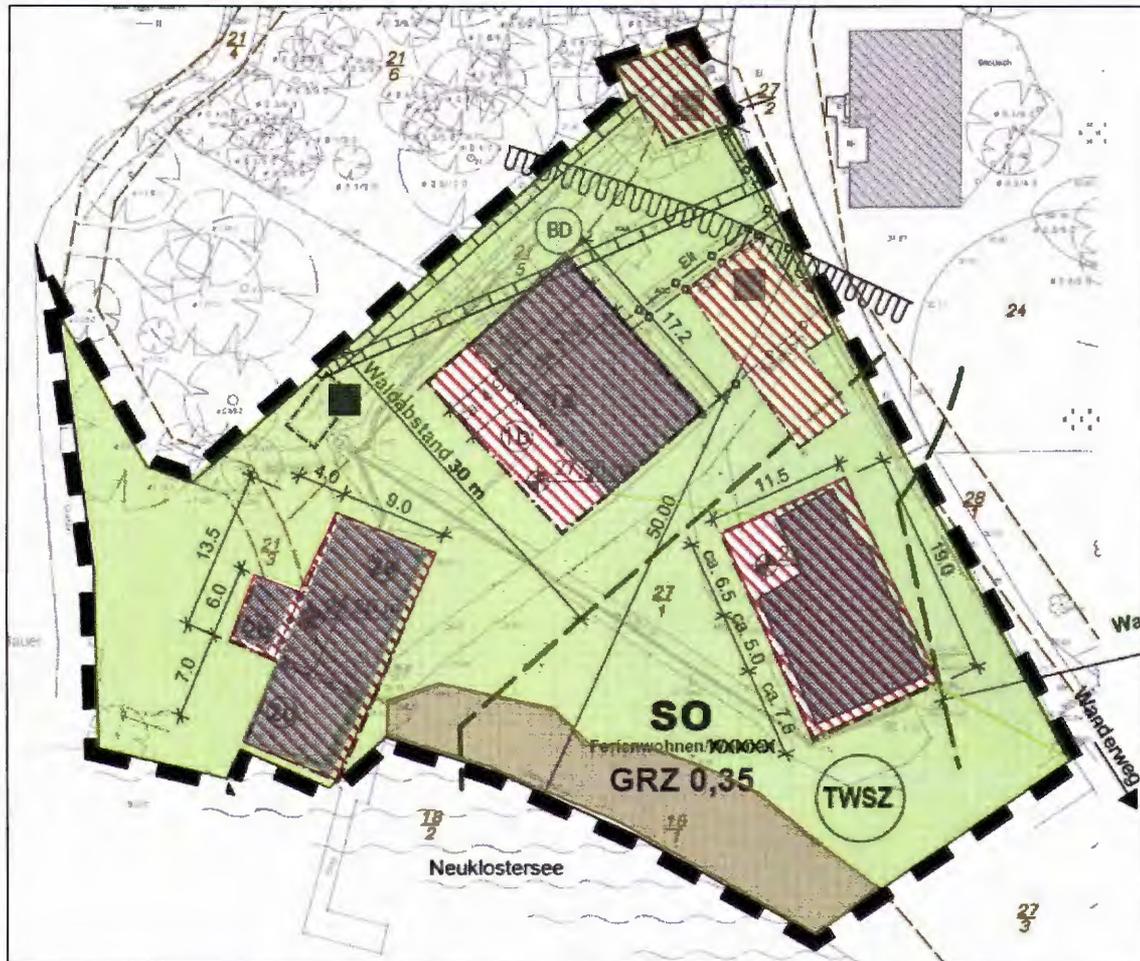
Darstellung der Biotoptypen im Eingriffsbereich. Grün: PGZ „Ziergarten“; Olivgrün: VRP „Schilfröhricht“; Grau: vorhandene Gebäude; Rote Schraffur: Eingriffsbereiche. Kartengrundlage: Bebauungsplan bab Wismar.
